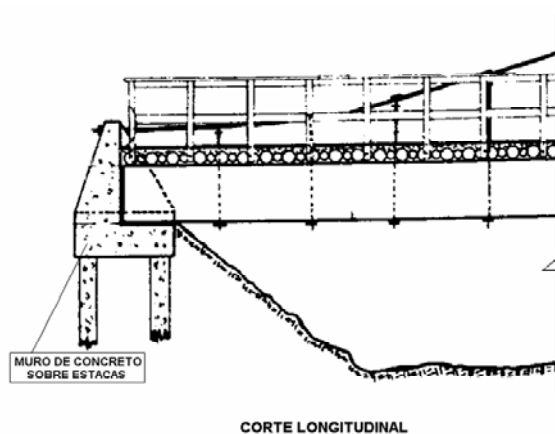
Fundação utilizando muro de concreto sobre estacas
